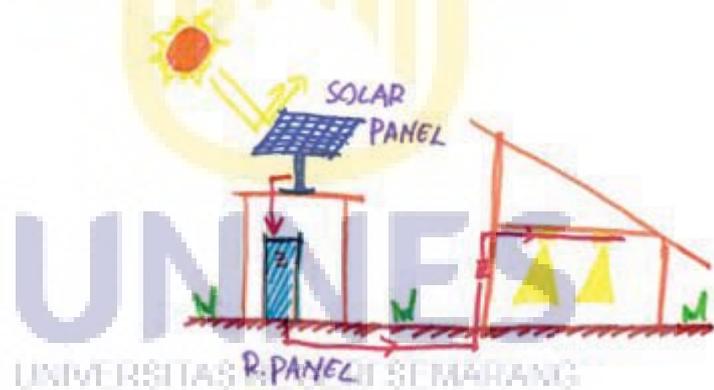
Instalasi Kabel Secara Ekspose dan Plafond
